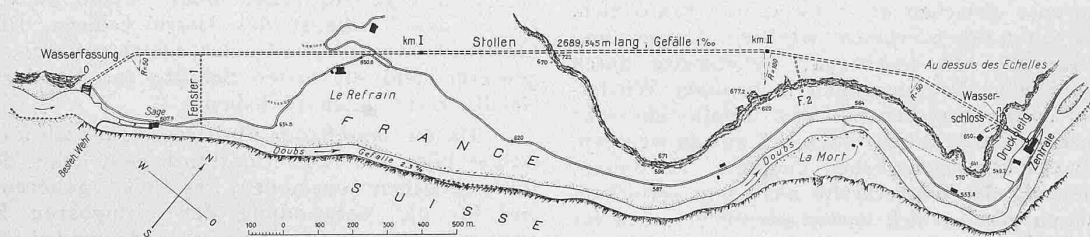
Lageplan von Wasserfassung, Stollen, Wasserschloss, Druckleitung und Zentrale. — 1 : 20000.
